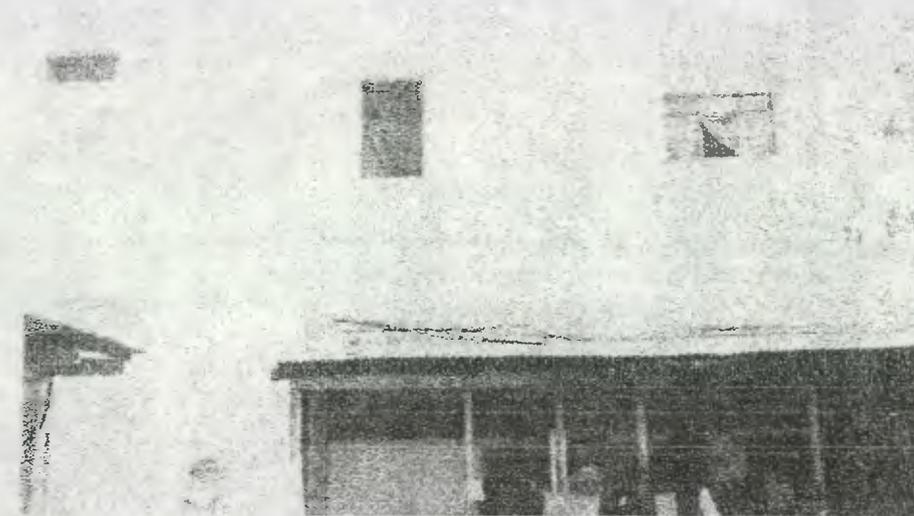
Parte posterior del edificio, 3° patio, planta alta: a) ventana pequeña, oficina del director; b) ventana vertical, final del corredor; c) ventana horizontal, comedor agregado. Planta baja: Guardianla (izquierda), bodega, servicios sanitarios (derecha).
